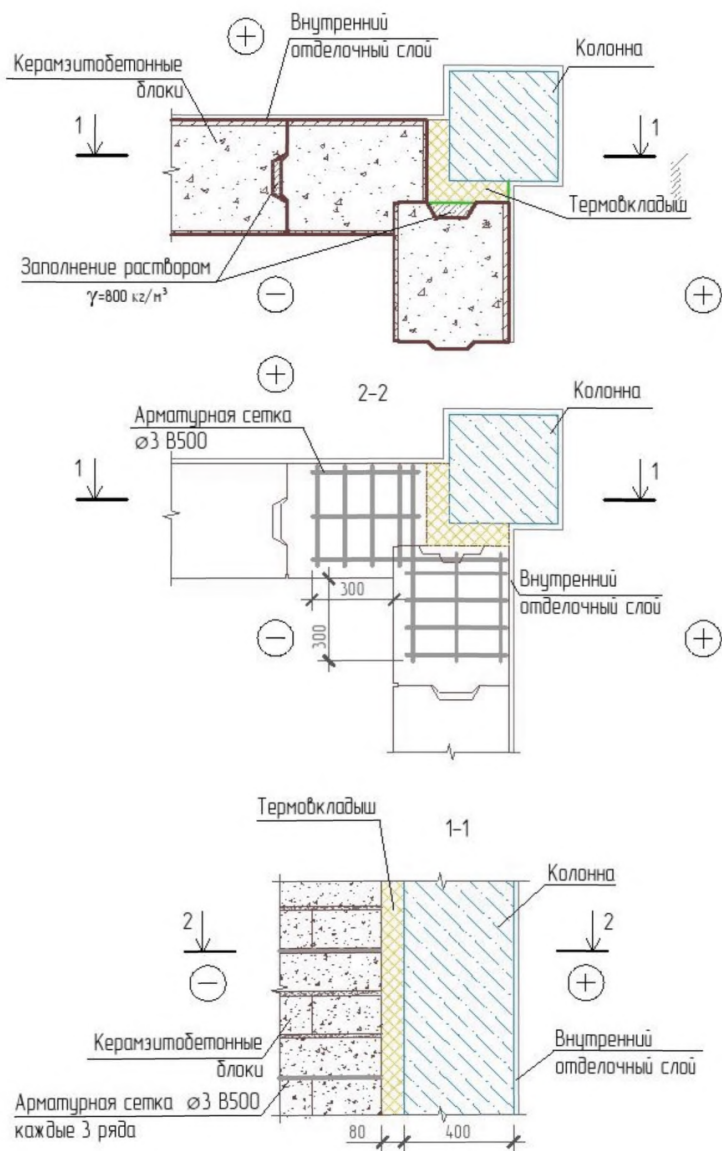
Соприжение стены с железобетонной колонной (Вариант 3)
